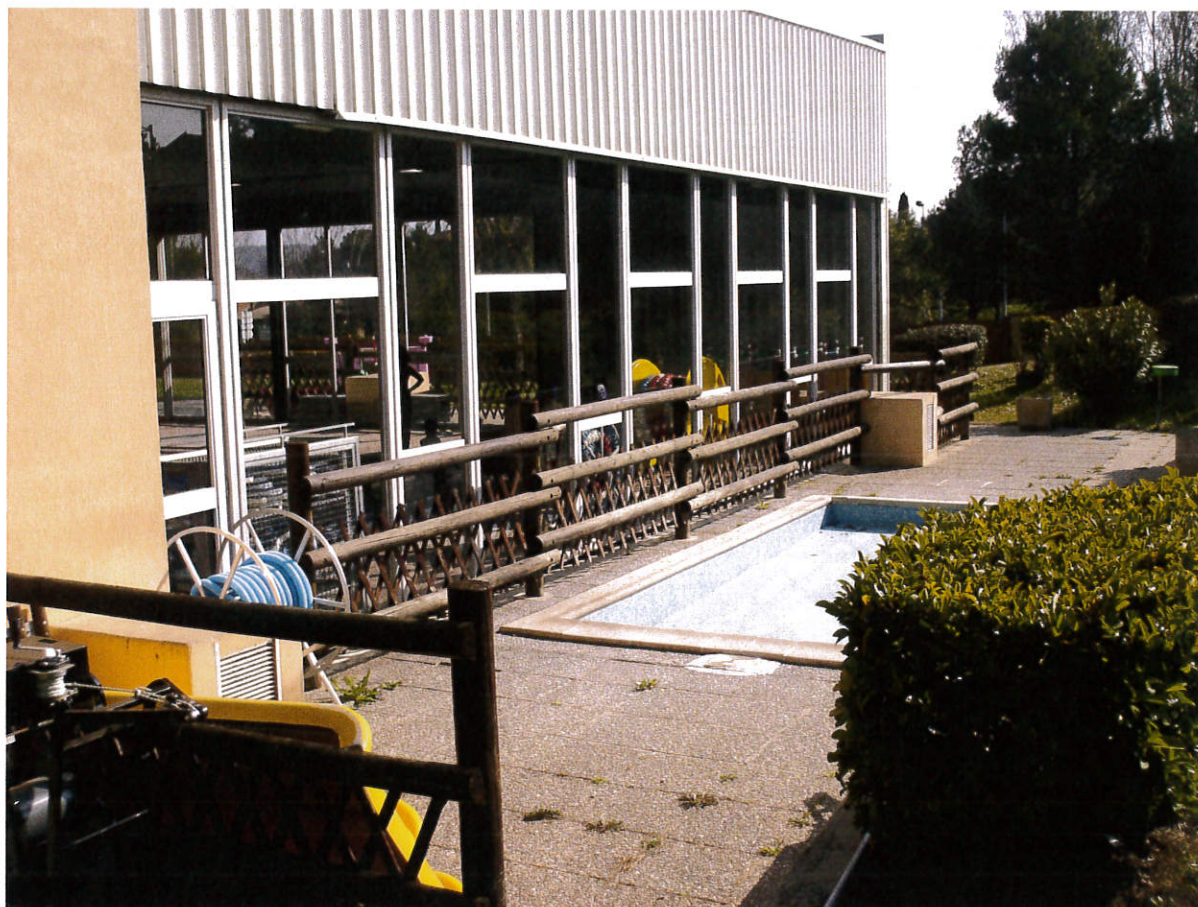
ANGLE FACADES OUEST ET SUD COTE ROND-POINT
